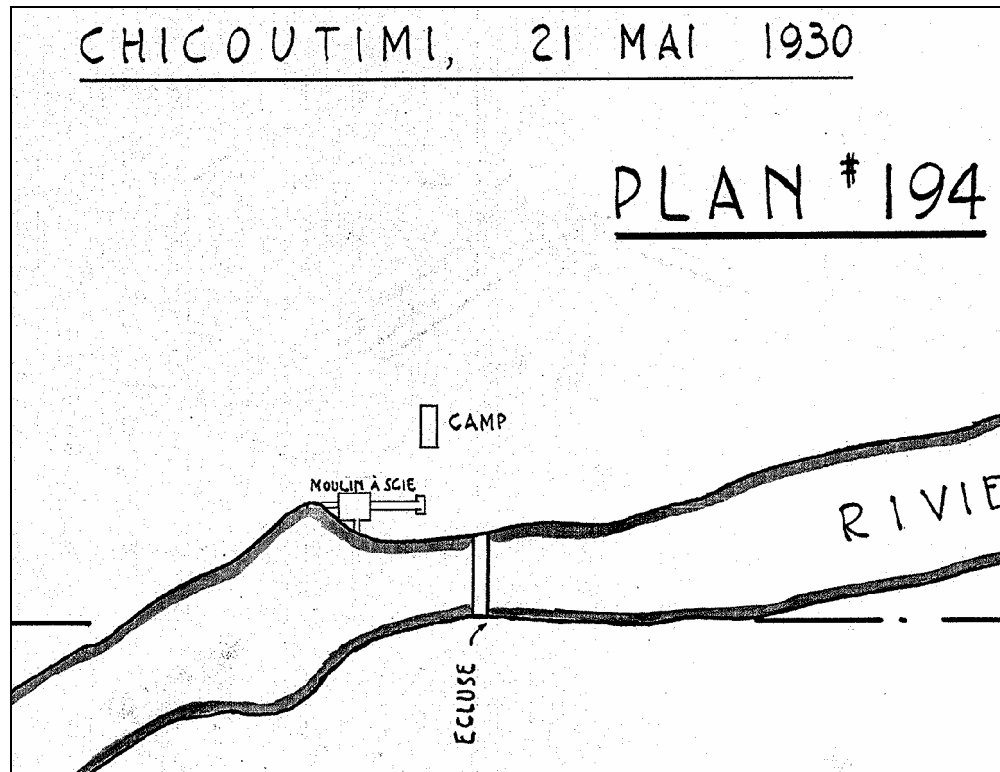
extrait du plan de la figure 22. Plan des installations de la chute Maligne, 1930.
